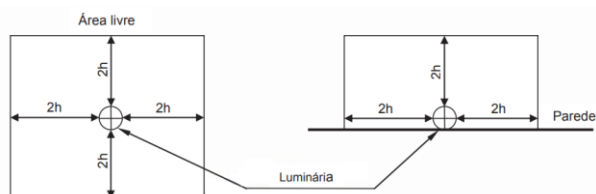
Exemplo de indicação de instalações de pontos de luz para iluminação de emergência em tetos ou paredes, em planta baixa.
